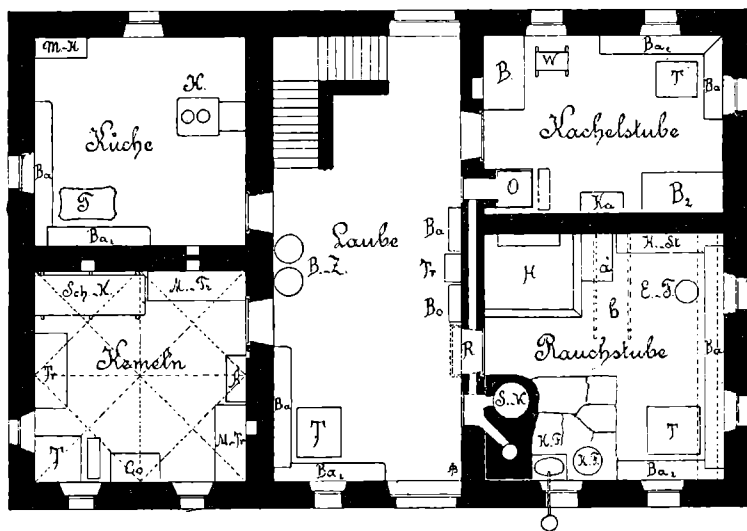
Grundriss des Erdgeschosses des Frankhofer-Hauses.
